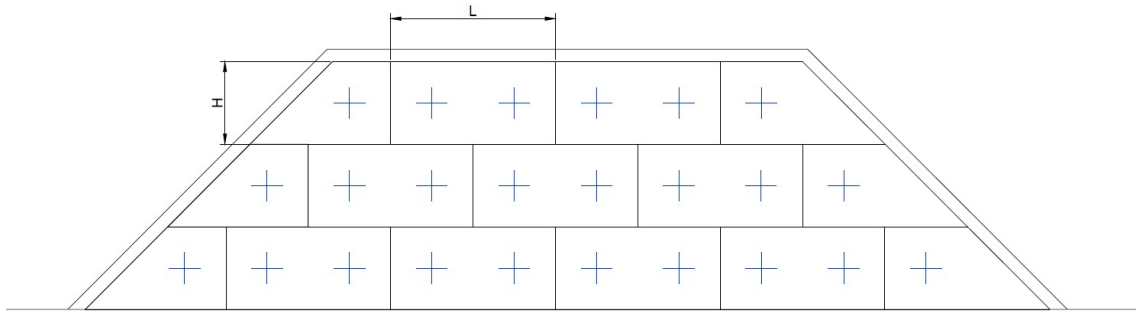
Ansicht einer geschlossenen verdübelten Elementwand
